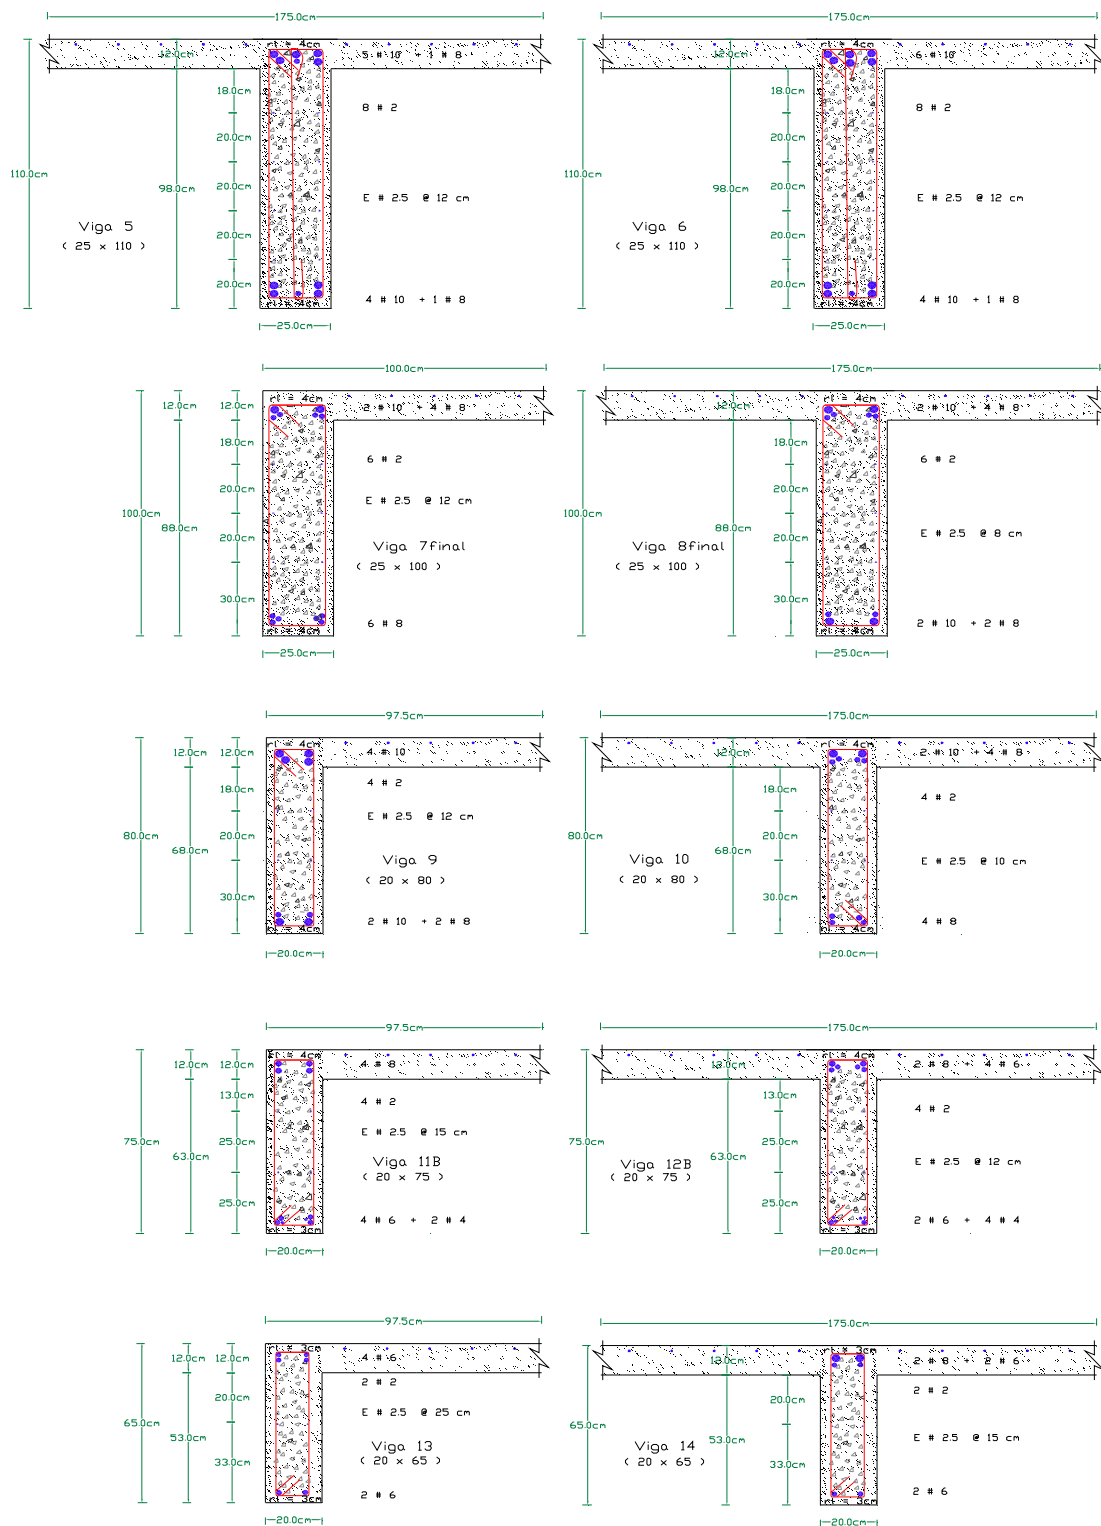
Dimensiones y armado de vigas, edificio III_9 (continuación)
